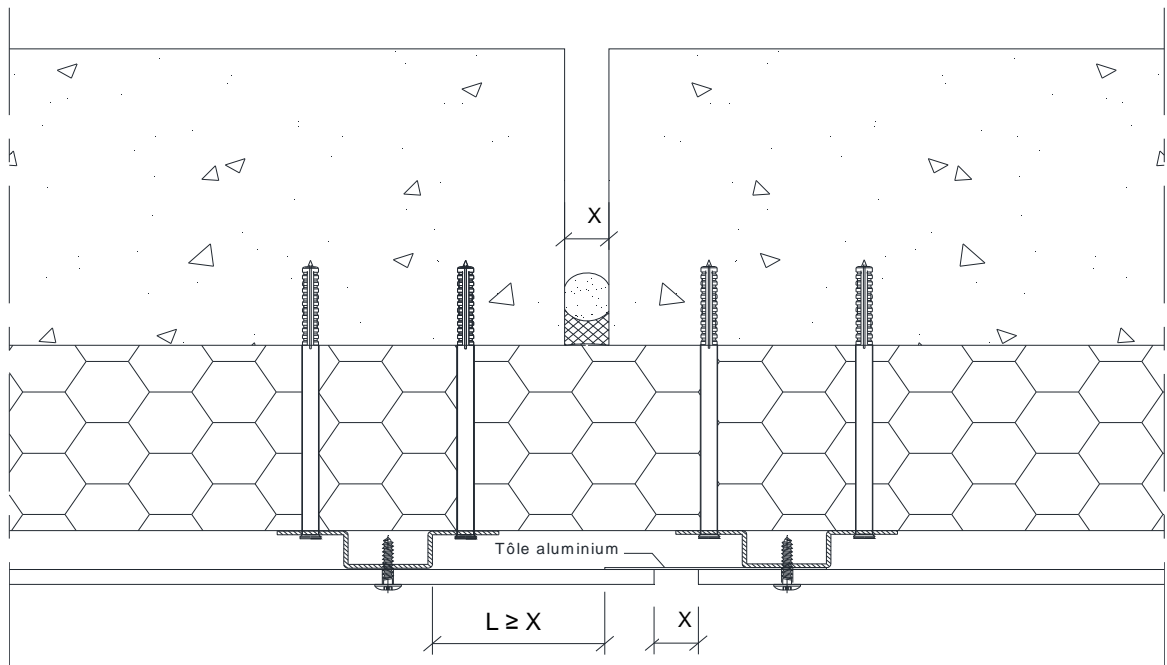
Joint de dilatation – Coupe horizontale - Vêtage
